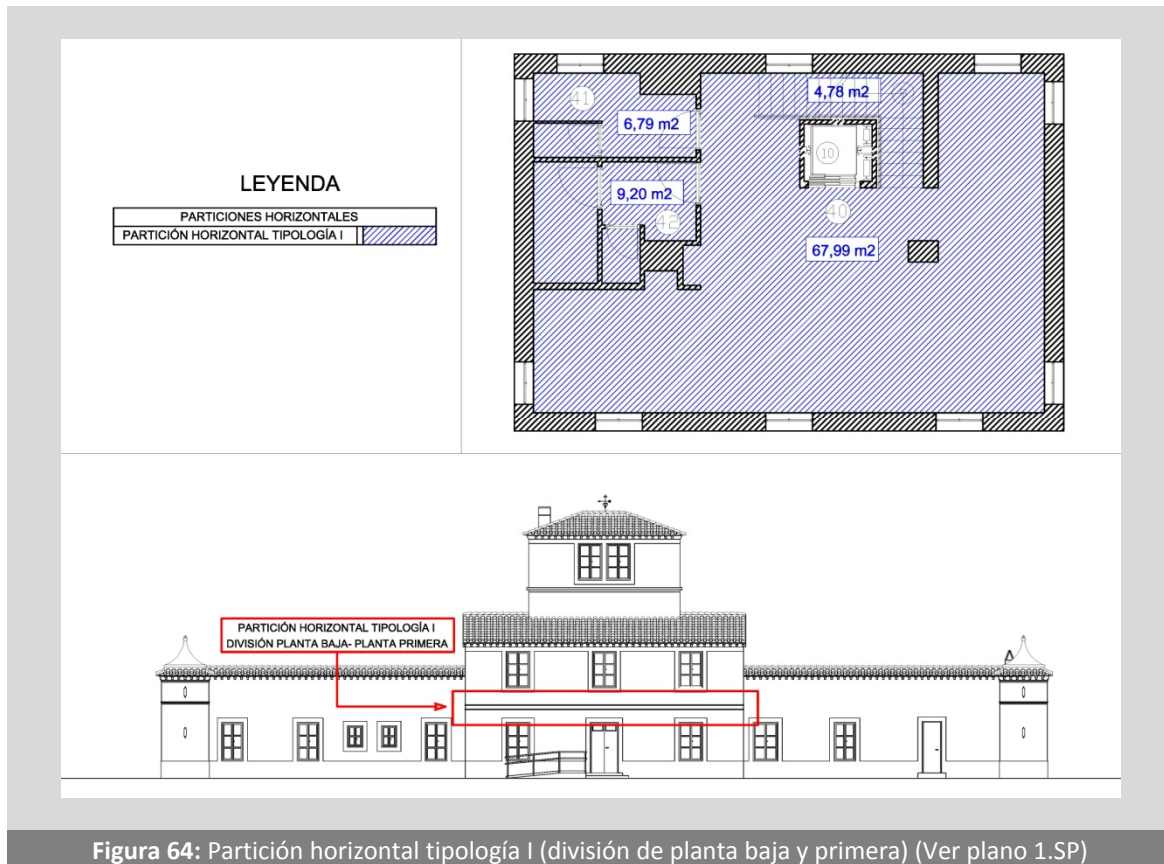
Partición horizontal tipología I (división de planta baja y primera) (Ver plano 1.SP)
